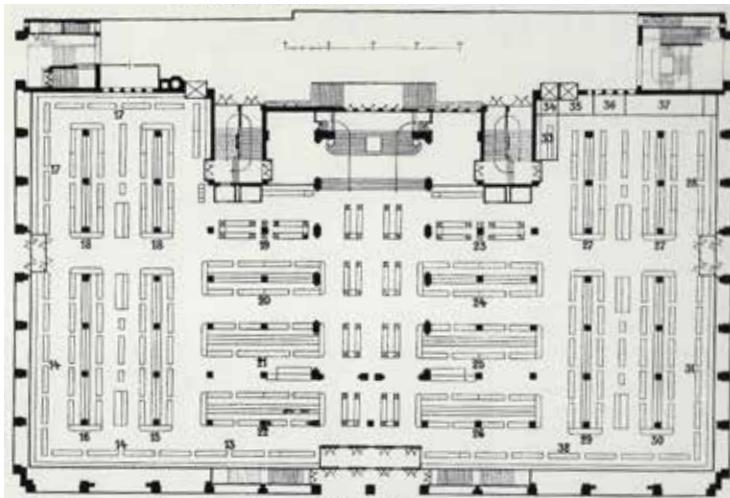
Warenhaus Tietz, Grundriss Erdgeschoss, 1908
